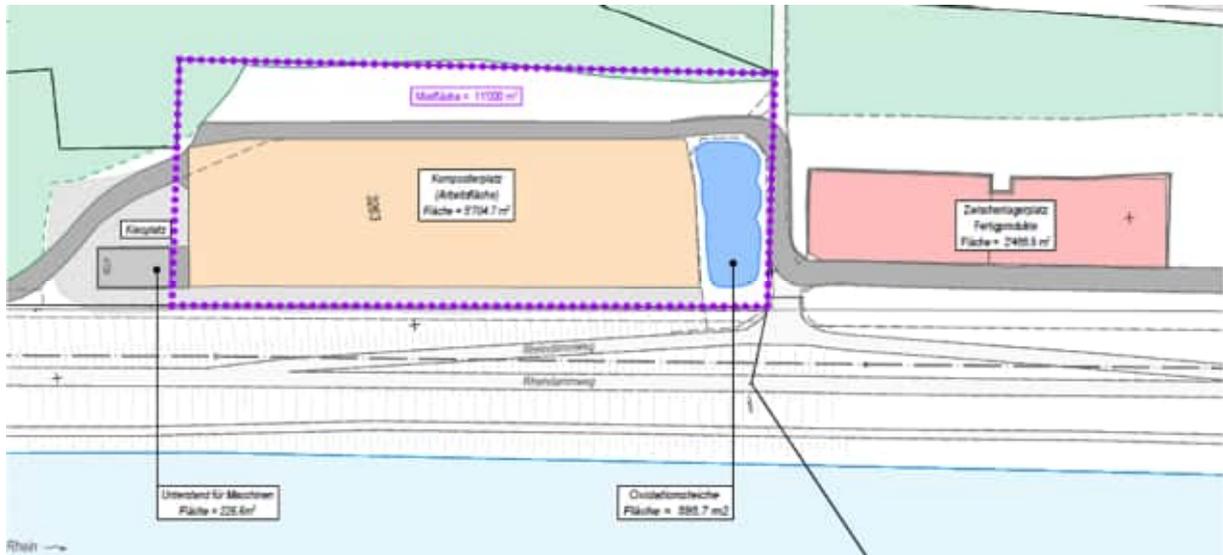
Planausschnitt „Projektstudie“. Übersichtsplan Situation 1:1'000. Plan Nr. 412-101. 17.08.2020. Ingenieurgesellschaft p.A. Sieber Cassina + Handke AG, Chur.
